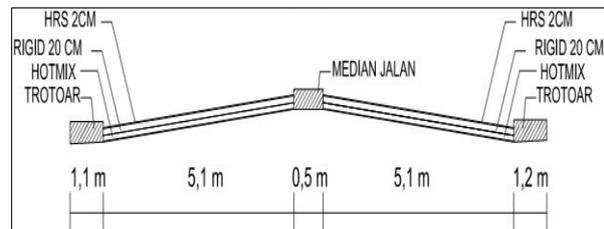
Geometrik Melintang Jalan D. I. Panjaitan Sebelum Peningkatan Struktur Badan Jalan
